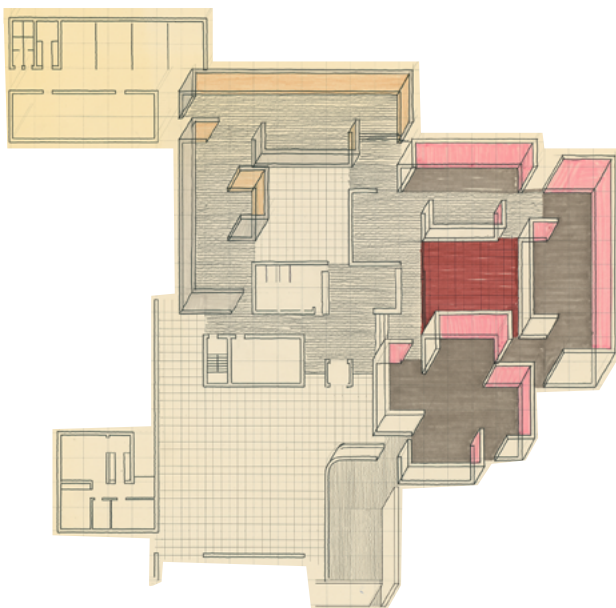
Entwurf Erweiterungsvariante Grundriss Werner Düttmann
